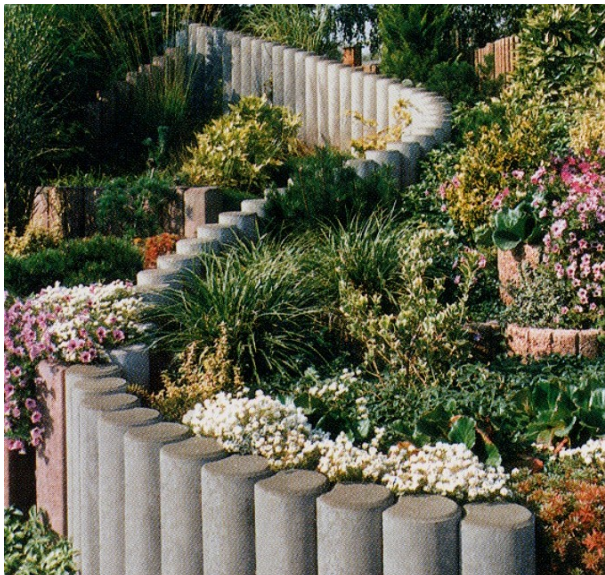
Mögliche Anordnungen von runden Betonhohlpalisaden
